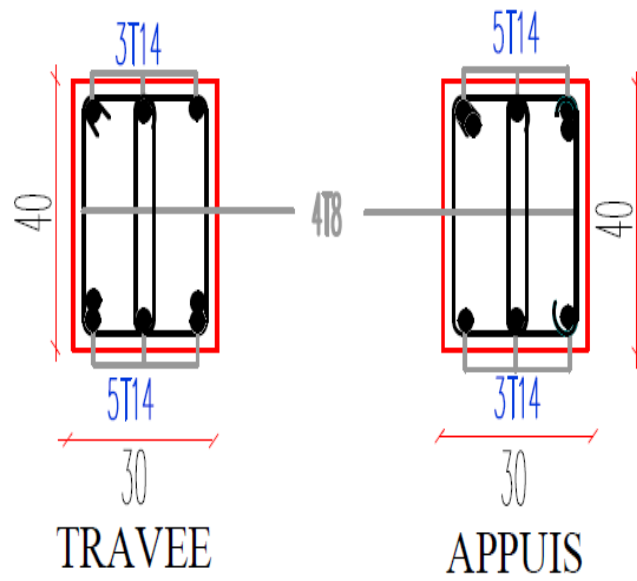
Schéma de ferrailage des poutres secondaire de la terrasse.
